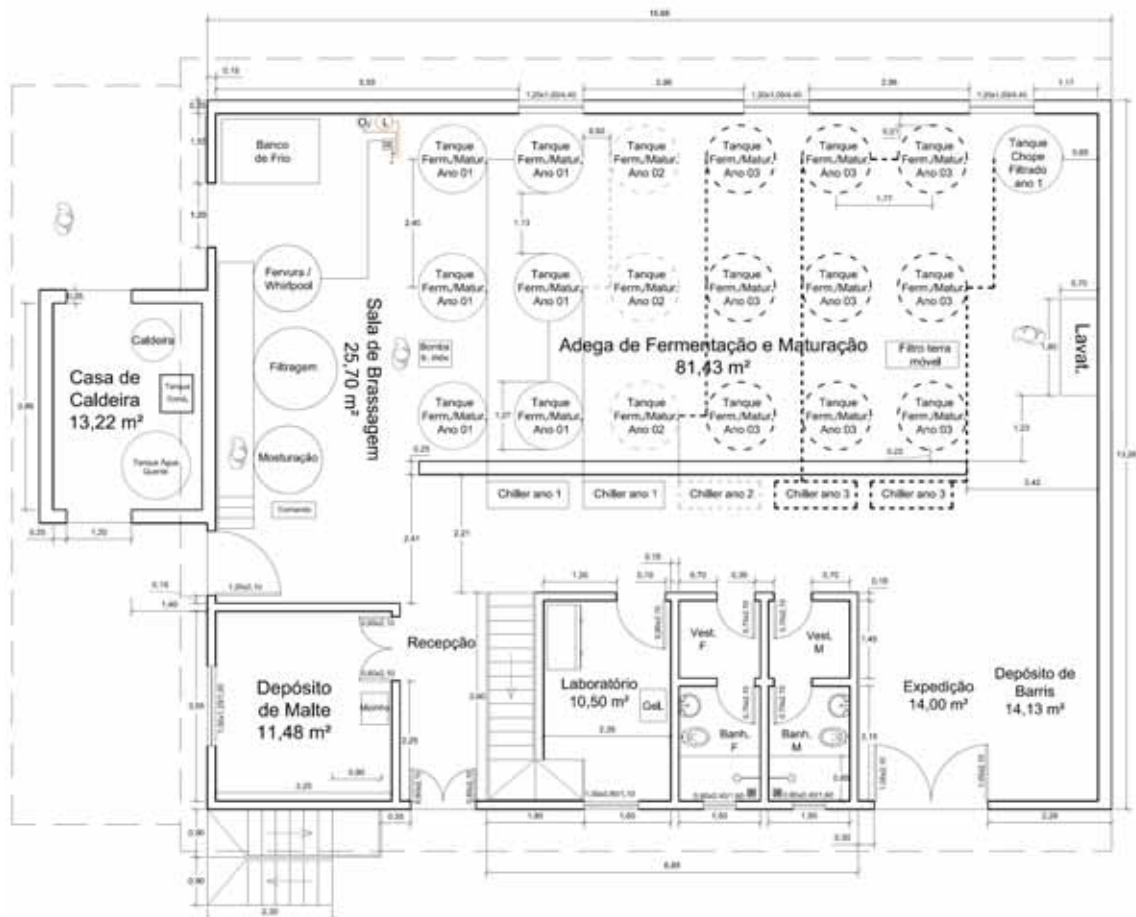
Planta baixa da unidade, com as projeções de implantação no segundo e terceiro ano (tracejado).
